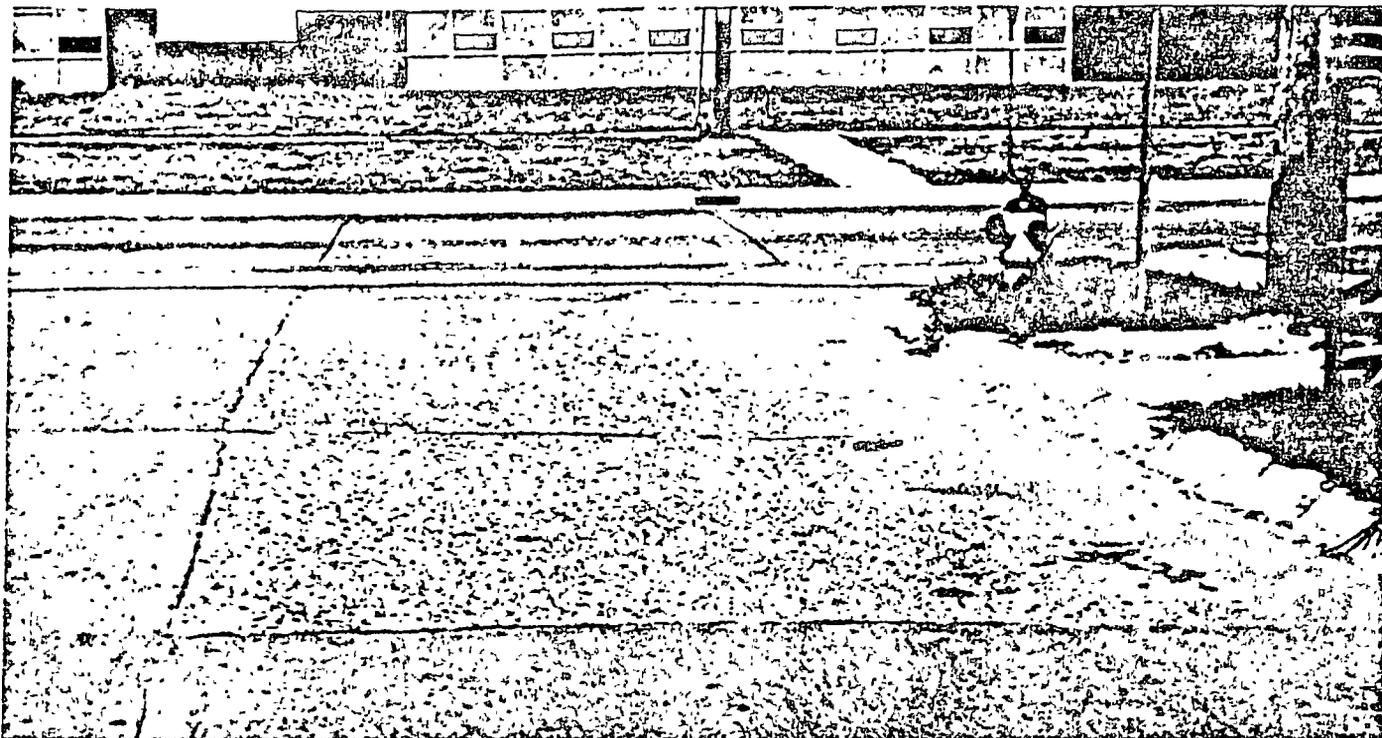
Dos losas de concreto con aire incluido fueron sustituidas por losas de concreto simple, después de haber fallado la base. La foto muestra que, después de una helada, las losas de concreto simple se afectaron seriamente por la acción del hielo; las losas de concreto con aire incluido que las rodean, en cambio, no sufrieron afectación alguna.
